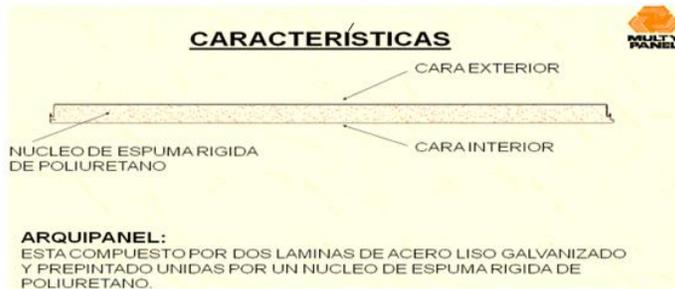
MUROS DE ARQUIPANEL Y/O A LUCOBOND.
